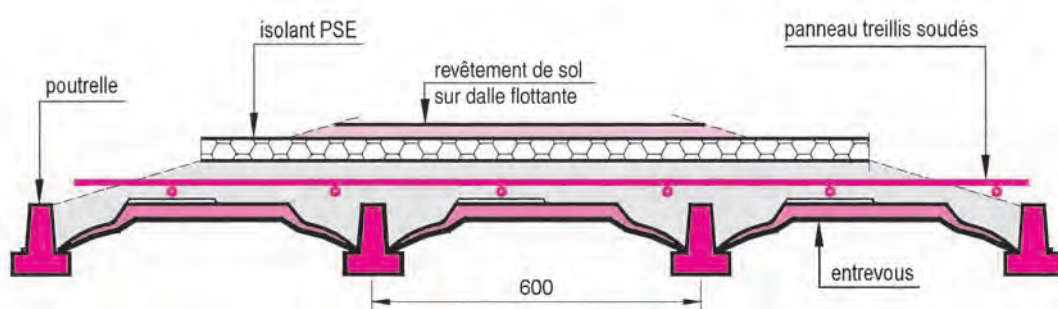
Plancher sur vide sanitaire avec dalle flottante sur isolant
